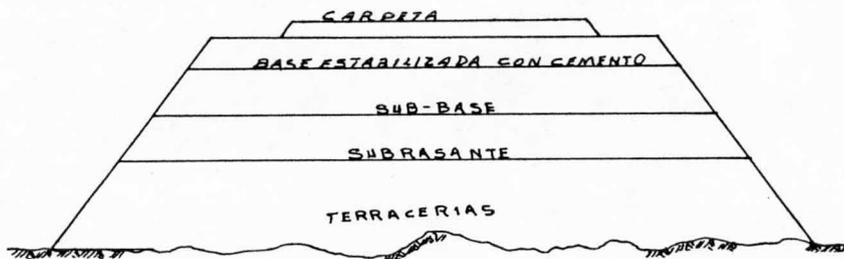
sección típica de un pavimento emirigido en terraplén.
